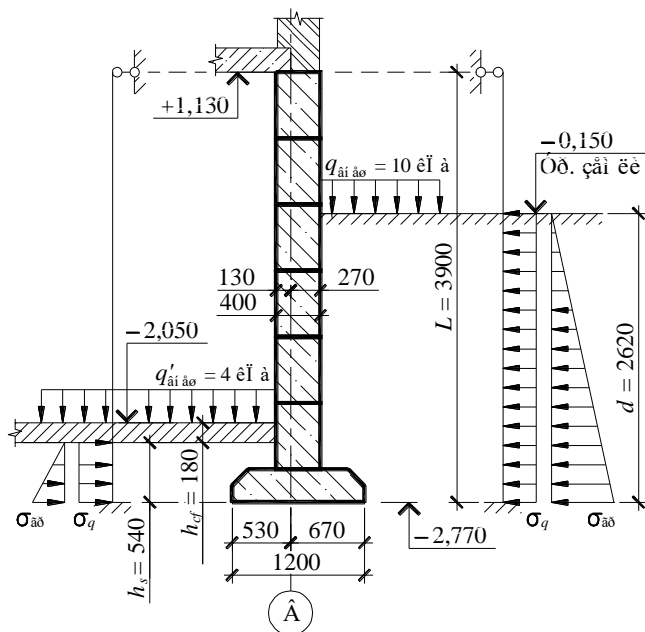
Схема действия бокового давления грунта на стену подвала фундамента Ф3
